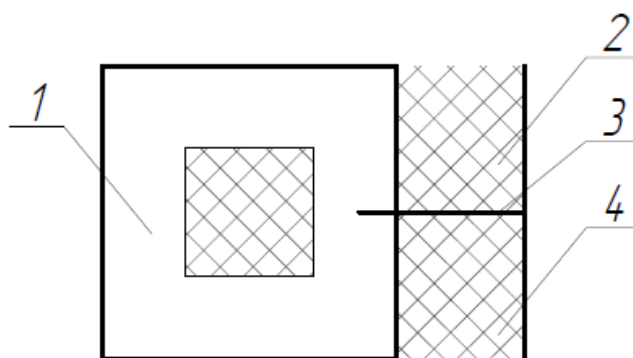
Розрахункова схема стіни з дерев'яного бруса і зовнішнім утеплювачем
